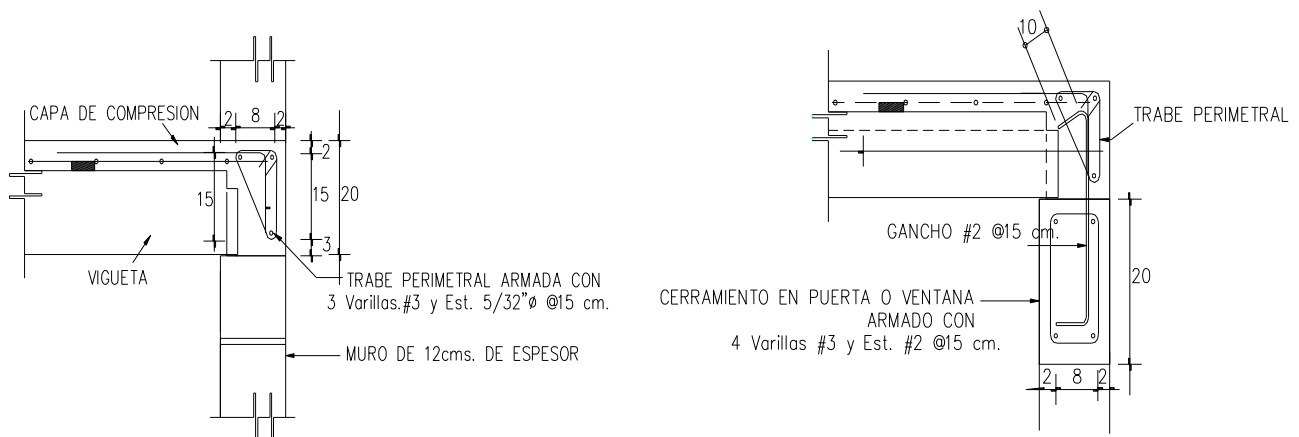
Armado de trabe perimetral y cerramiento
